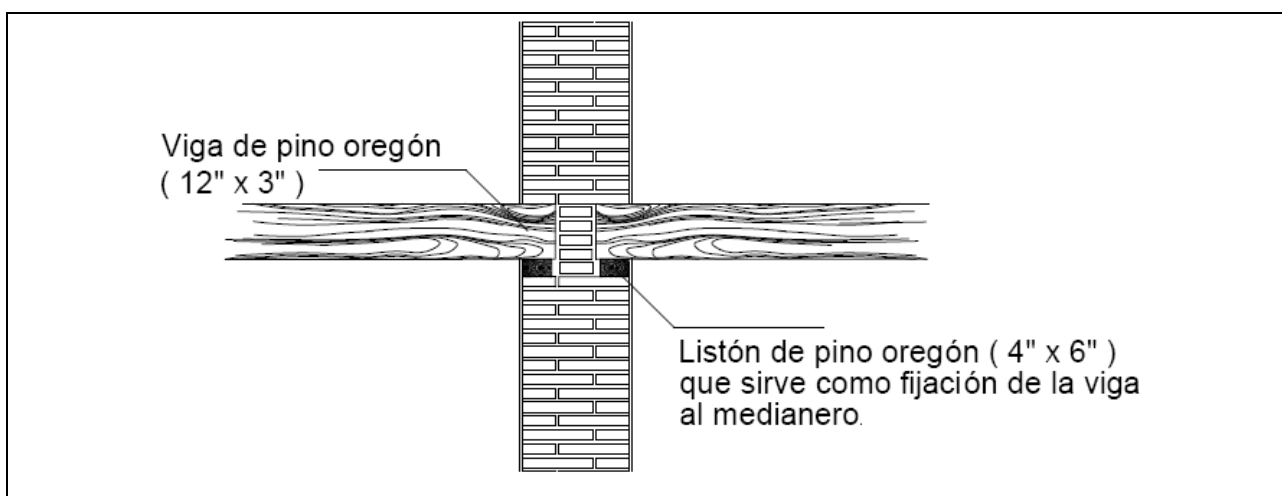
Detalle del apoyo del sistema de piso en los ejes interiores (Taller Intramuros, 2007).
